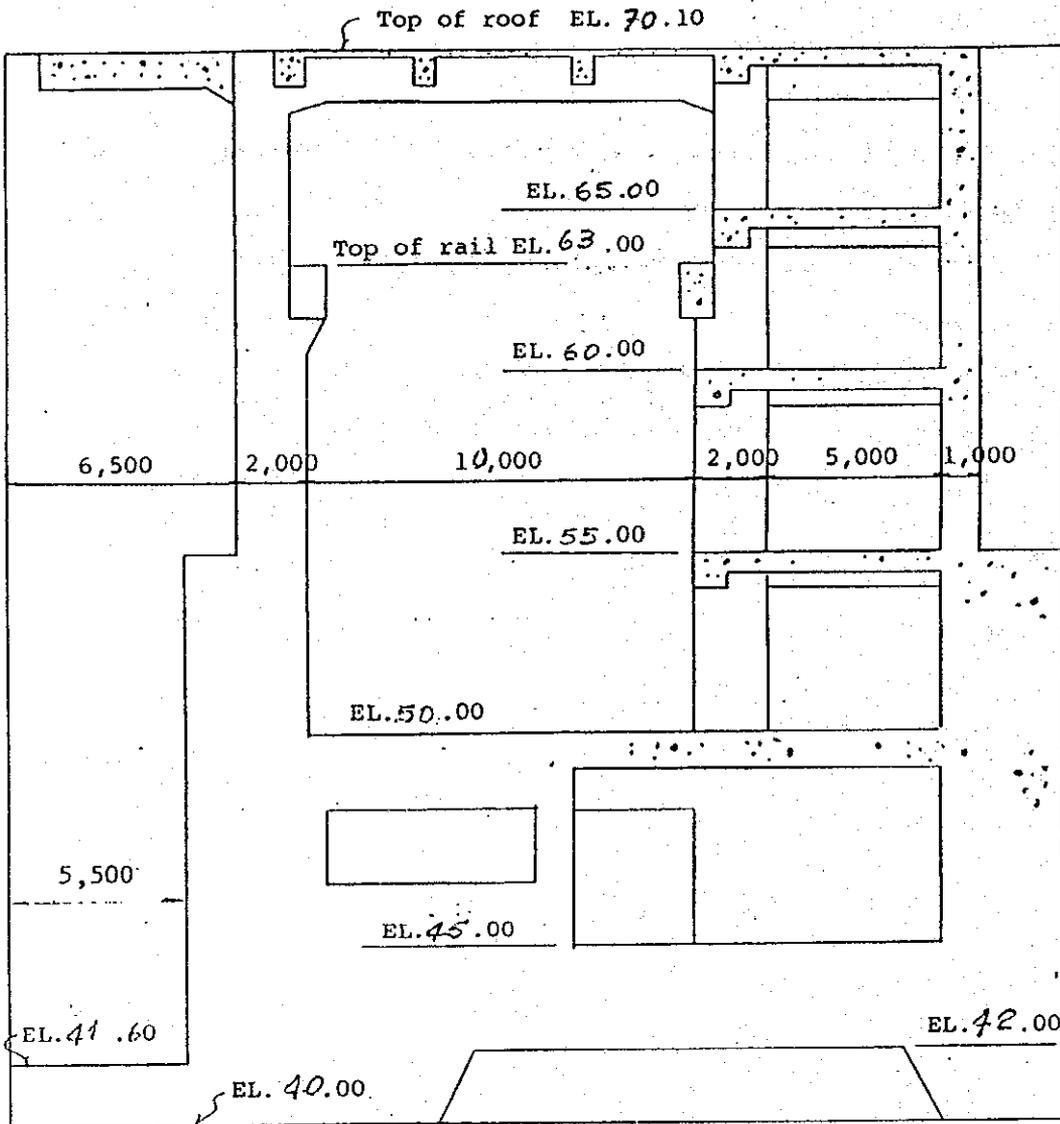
MODELO ESTRUCTURAL DE VIGAS Y LOSAS
